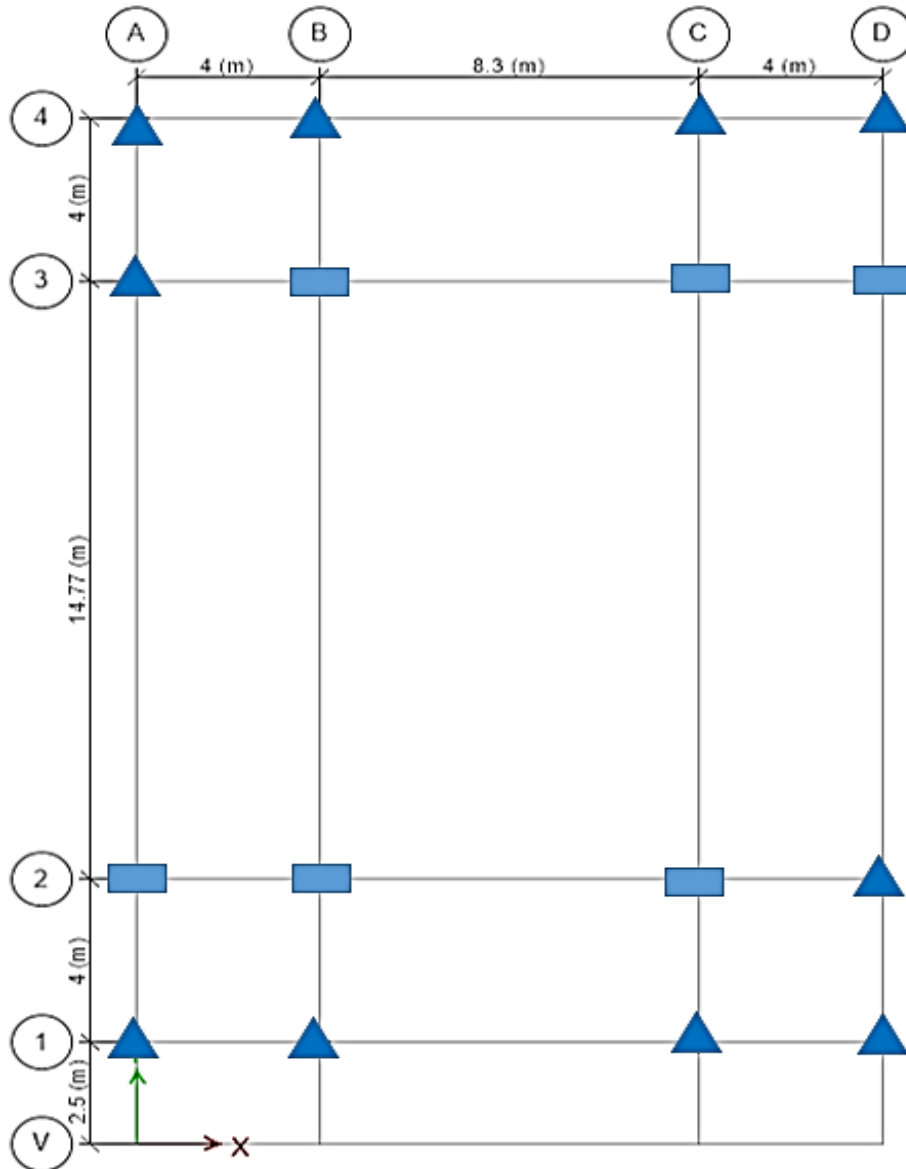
Estructuración de cimentación articulada y cimentación empotrada para el proyecto
